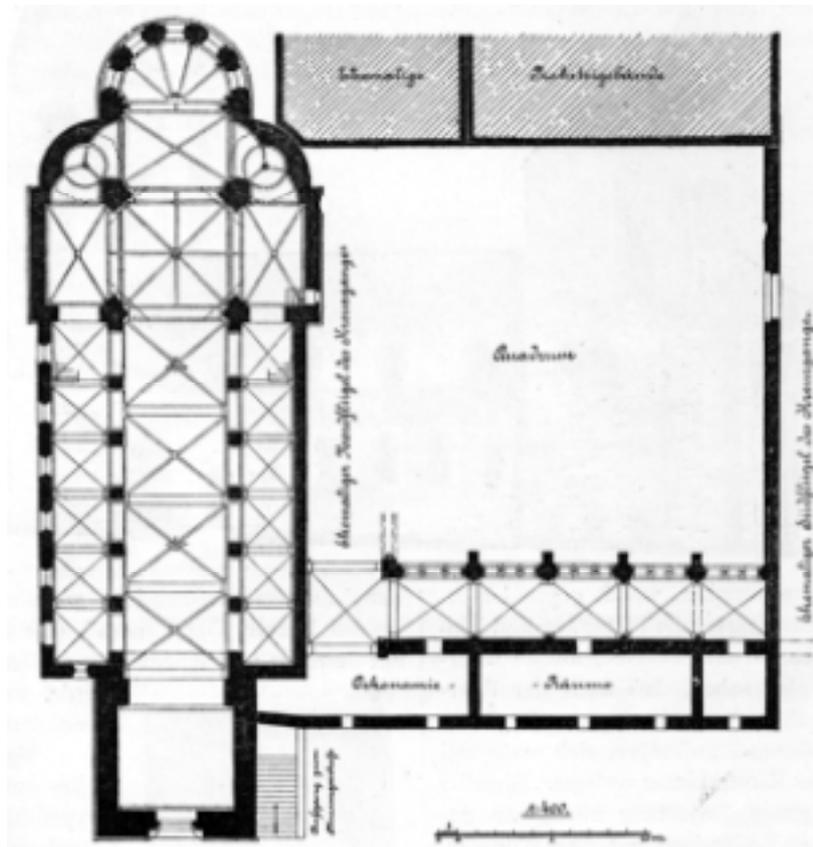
Grundriss von Kirche und Kreuzgang
